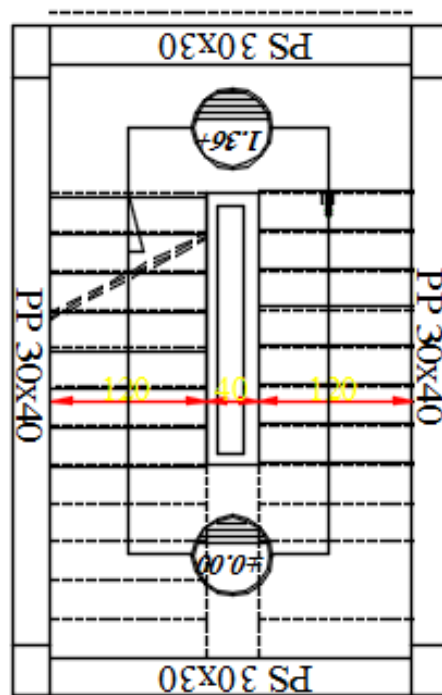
Vue en plan de la cage d'escalier type1.
